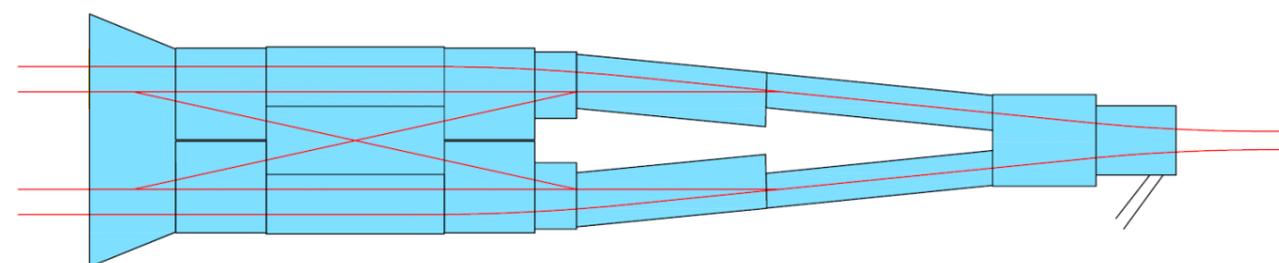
Principes de construction de l'entonnement en ouvrages élémentaires
